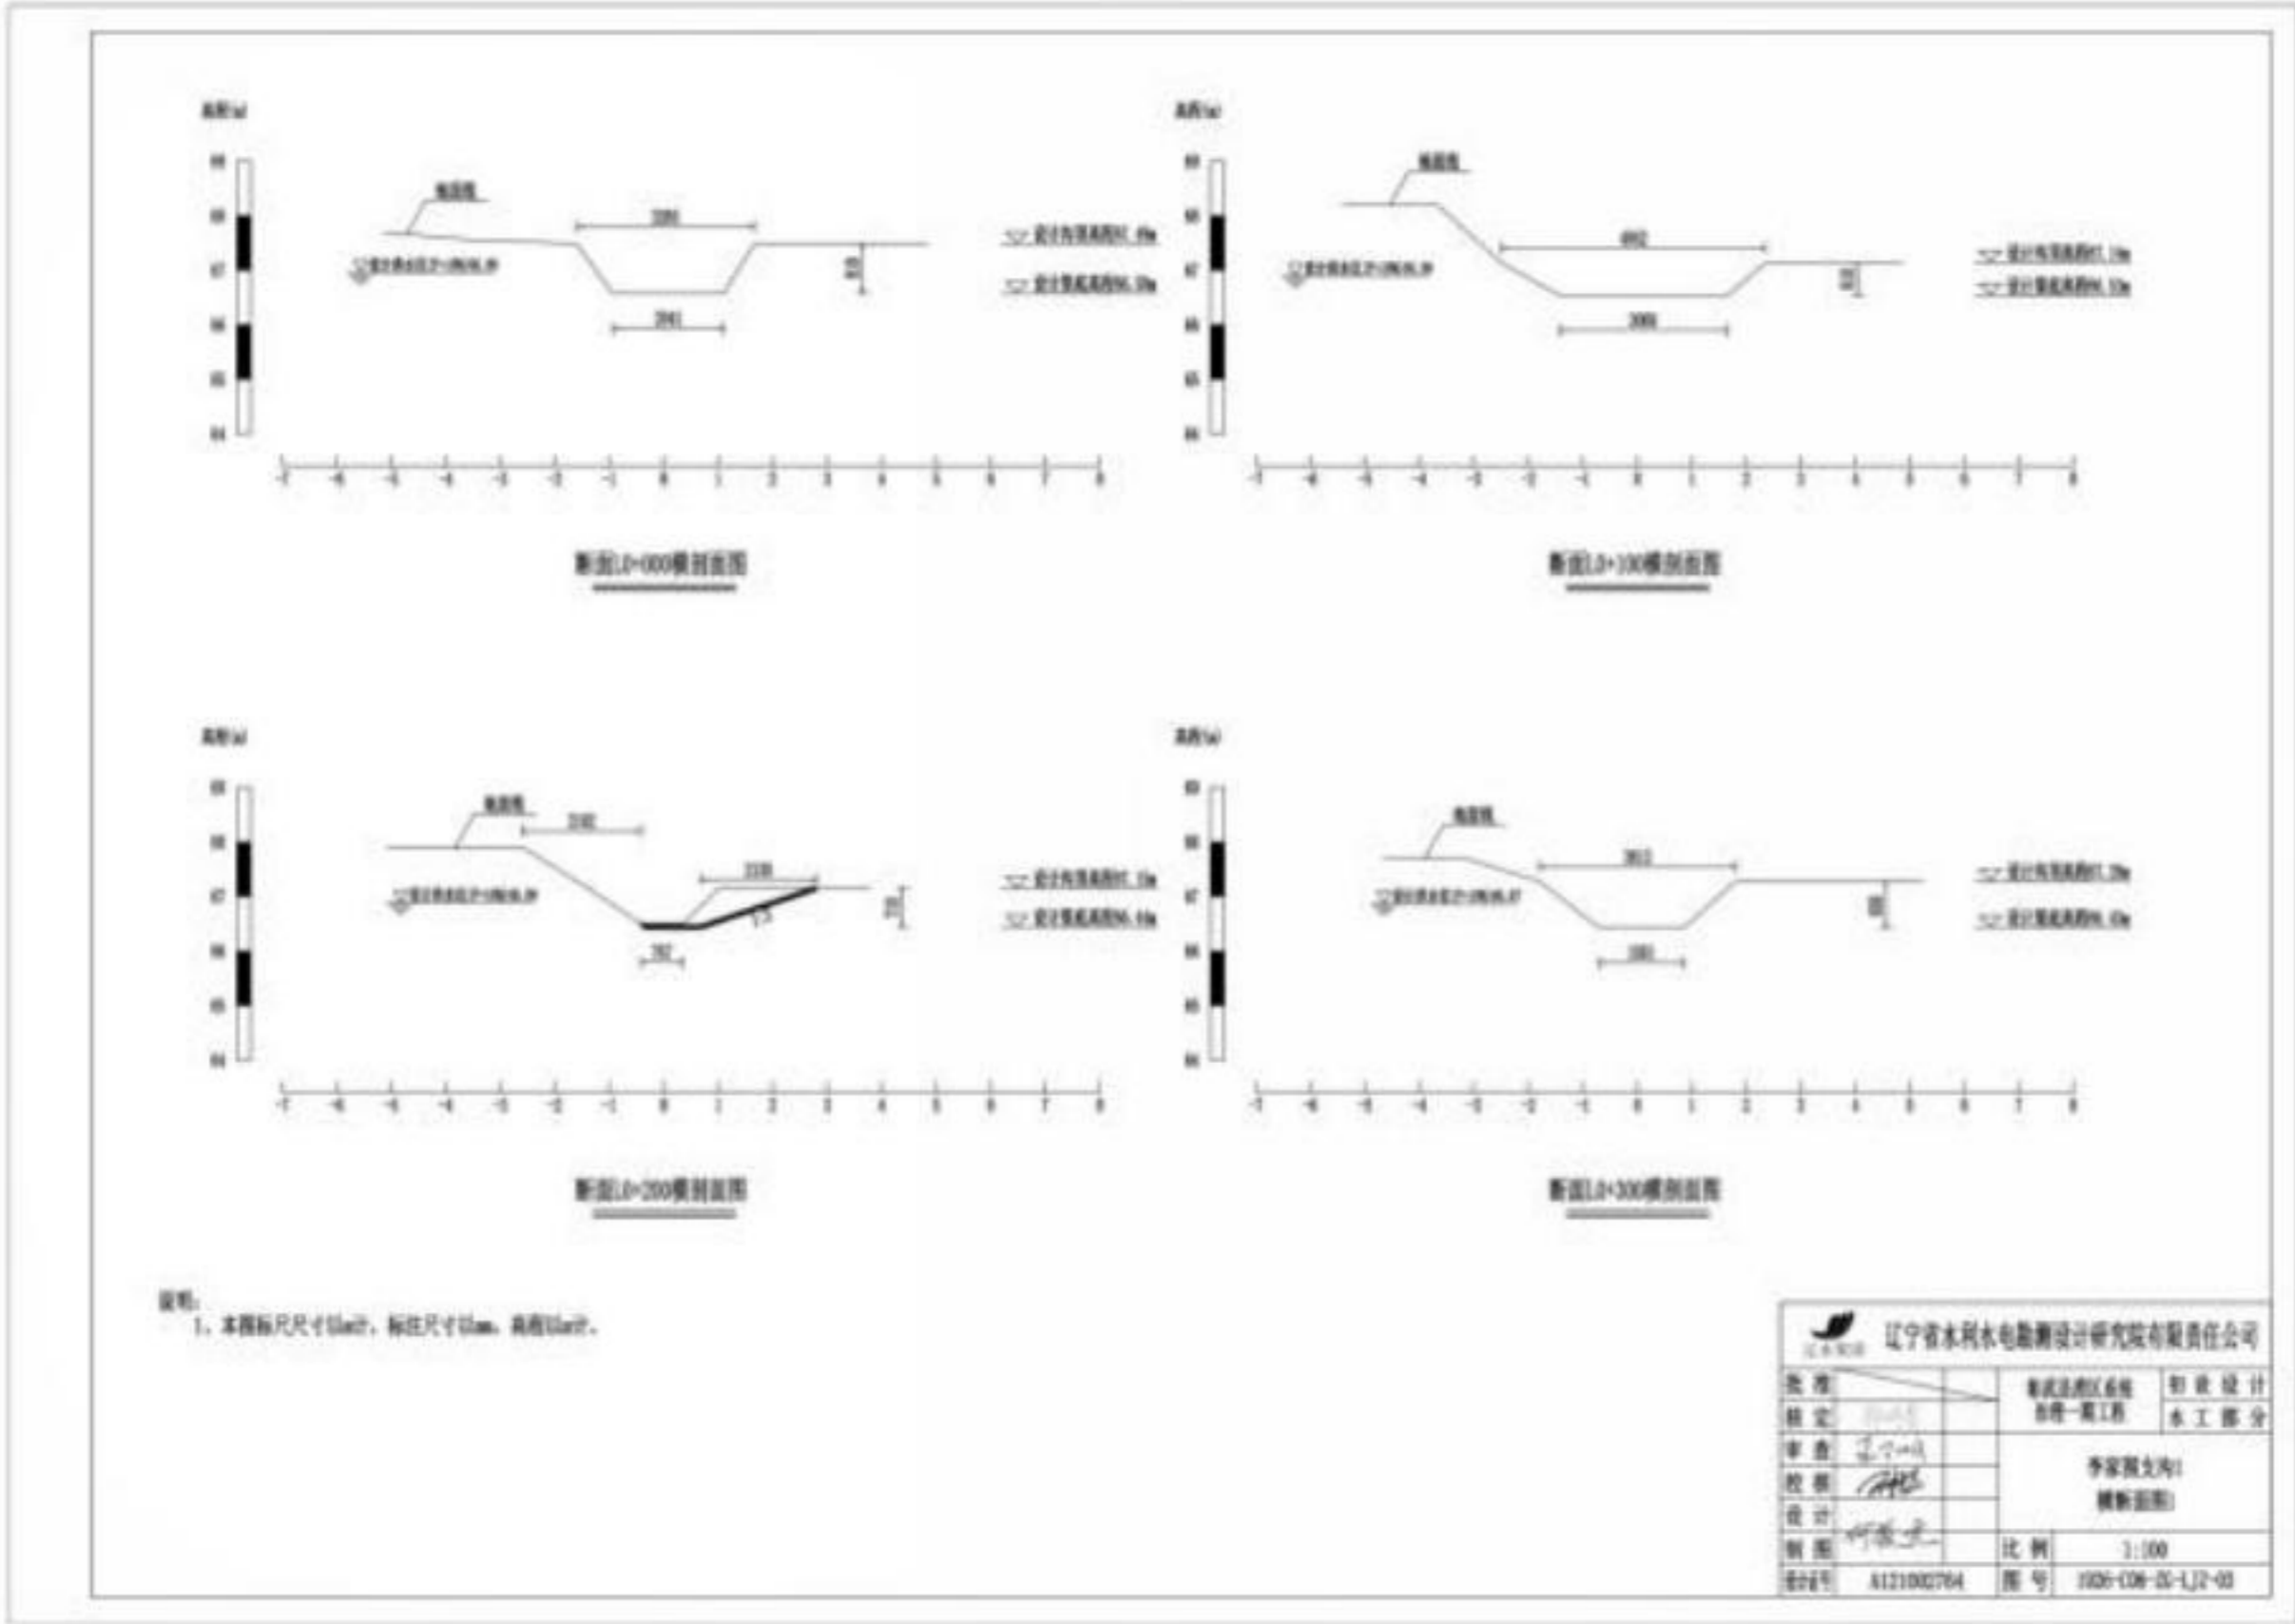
(1) 两家子镇李家围支沟 1 剖面图
